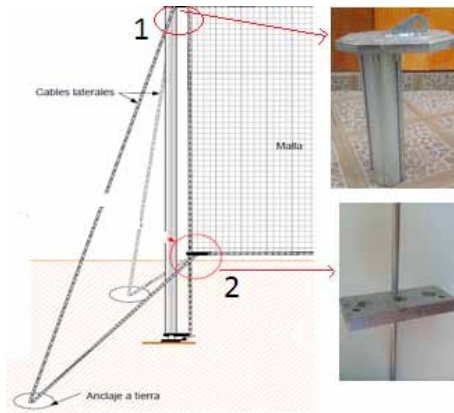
Unión de cables, horizontales y verticales, con las piezas 1 y 2 del atrapanieblas (Proyecto Atrapanieblas)
